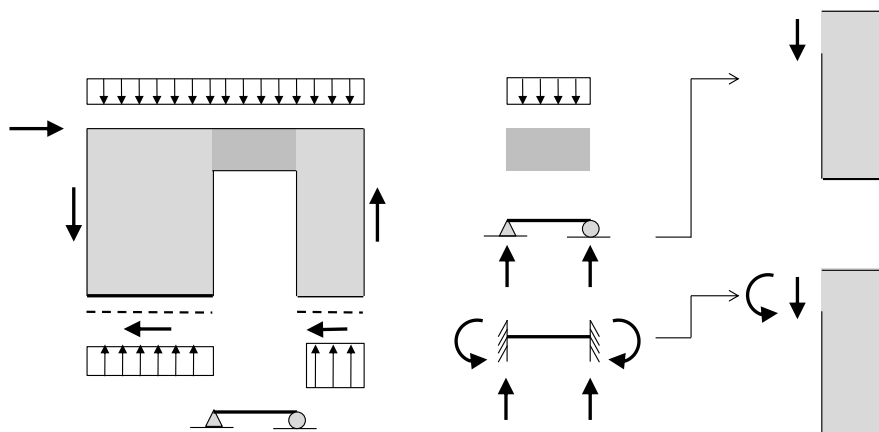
Parete con apertura e schema strutturale della parte con funzione di architrave
